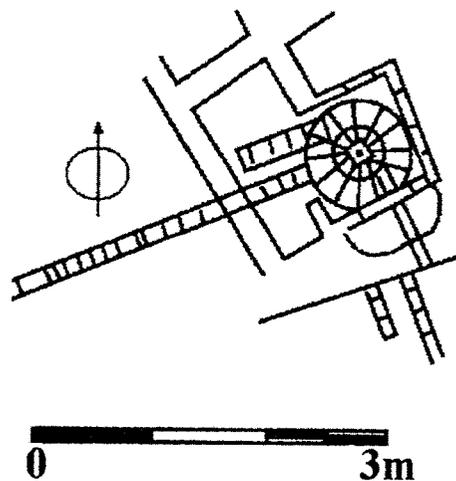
Detalle de la estructura de la fuente, según el plano original de Chamoso Lamas (1976).
